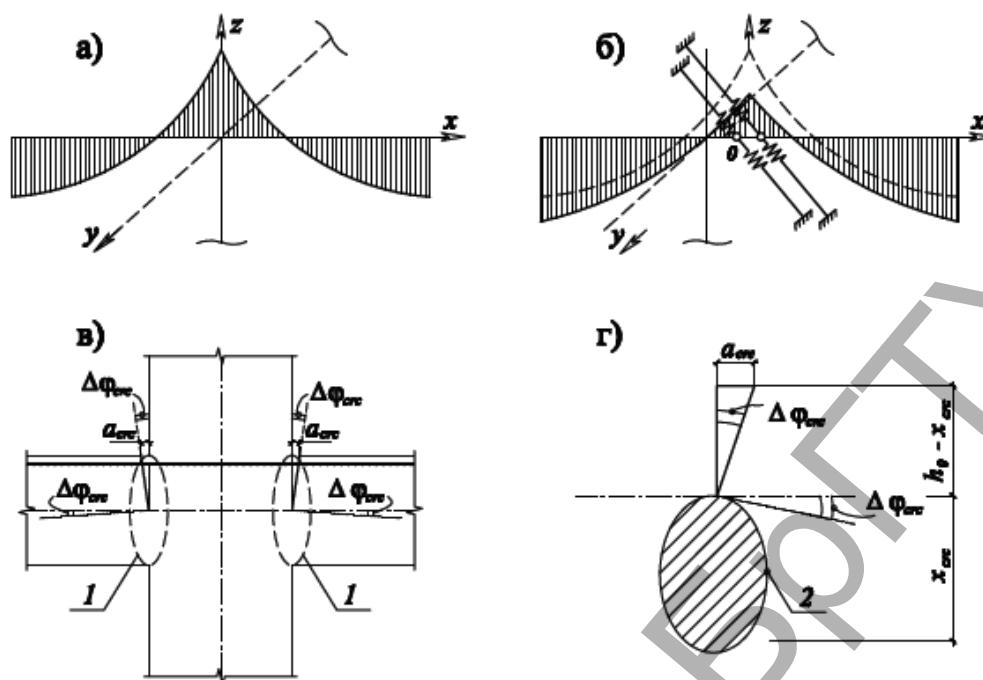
К учету повышенной деформативности узлового сопряжения рамного железобетонного узла (эпюры моментов вдоль оси y условно не показаны): а – расчетная схема с жестким сопряжением; б – то же, при учете податливости сопряжения; в – схема трещин в углах узла, вызванных концентрацией напряжений; г – к определению дополнительного угла поворота $\Delta\varphi_{crc}$: 1 – зоны повышенной деформативности; 2 – зоны кинематического поворота в сжатом бетоне
